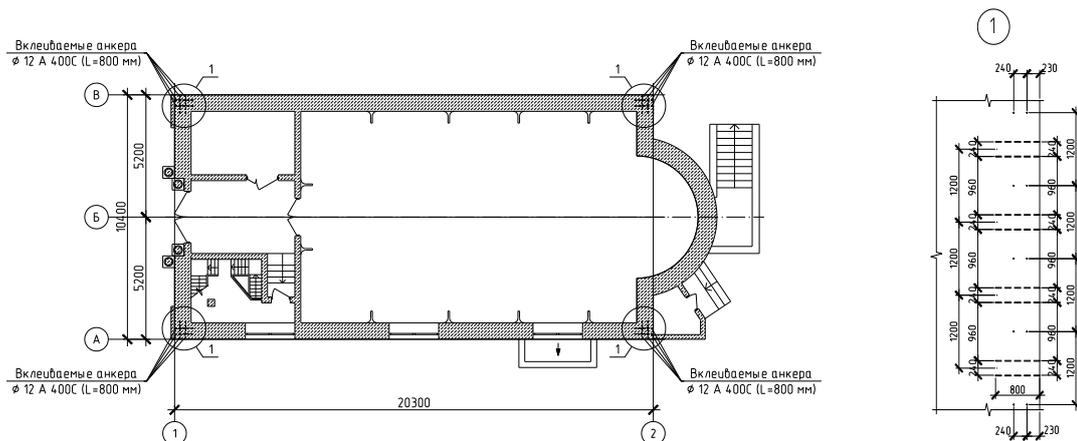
Усиление пересечений наружных стен вклеиваемыми анкерами храма святого Архистратига Михаила
